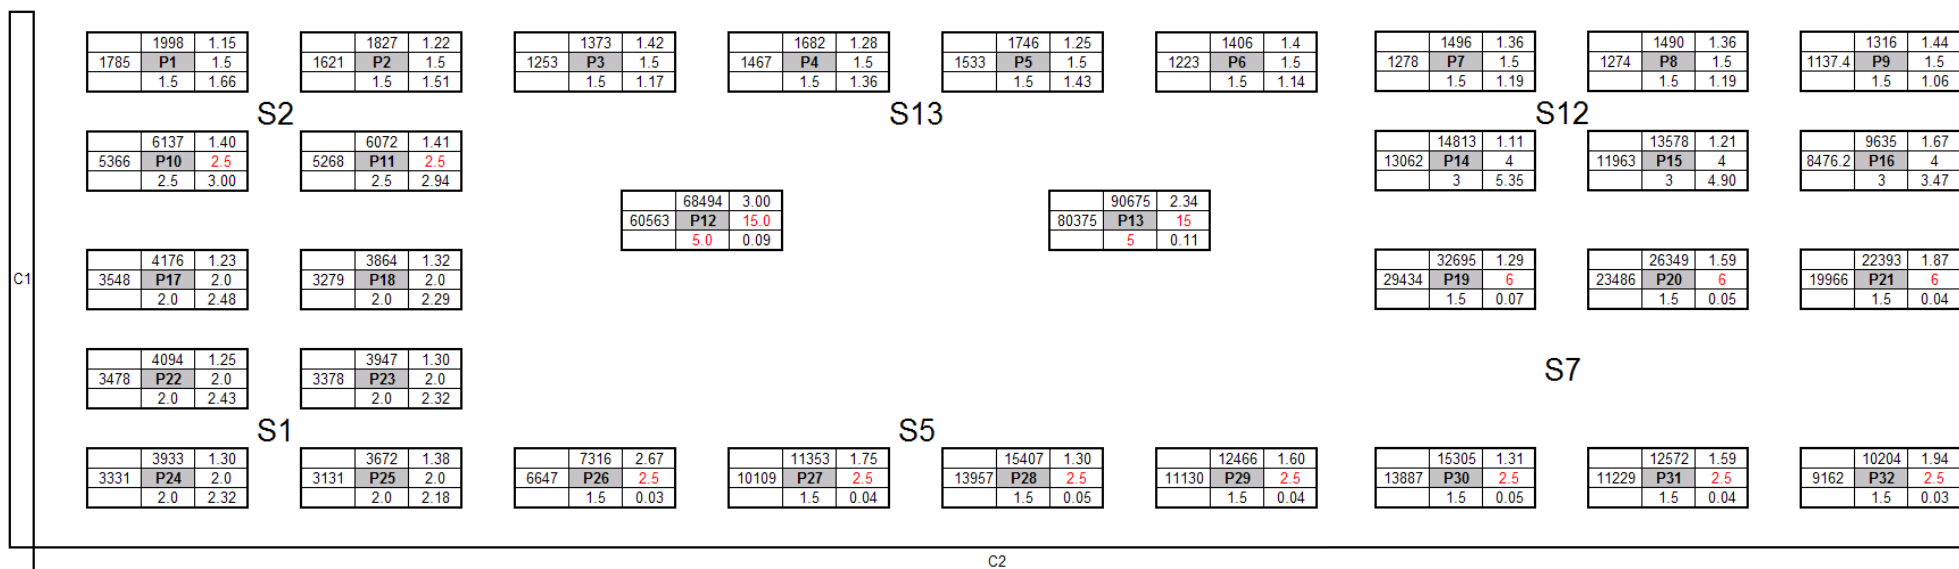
Planta esquemática e resultados (reações e assentamentos) das sapatas de fundação (apoio rígido).
